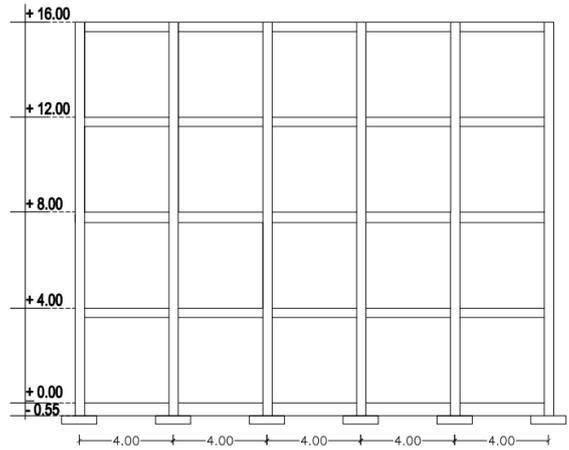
(Model A) Denah portal gedung tanpa struktur *tie beam
